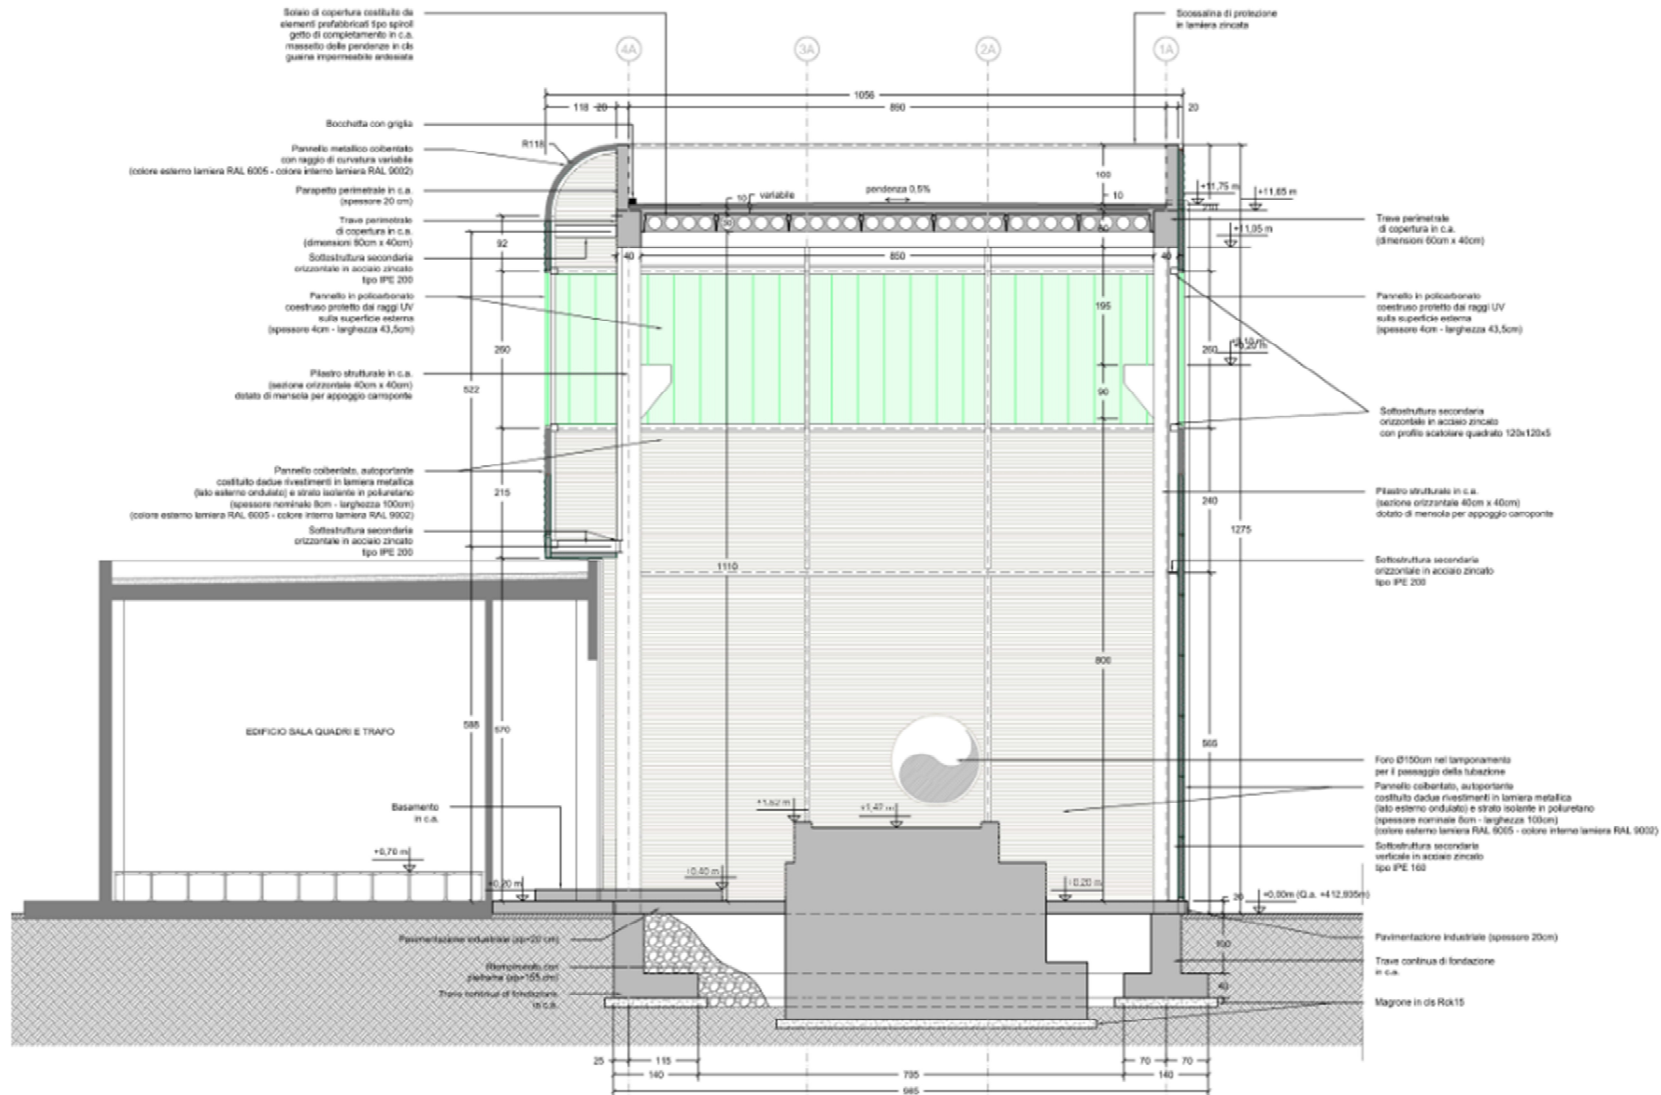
Edificio Ciclo Termico – Sezione trasversale B-B
